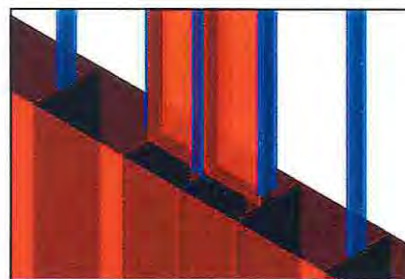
Desvinculación de columnas de fachada vista 3D.
